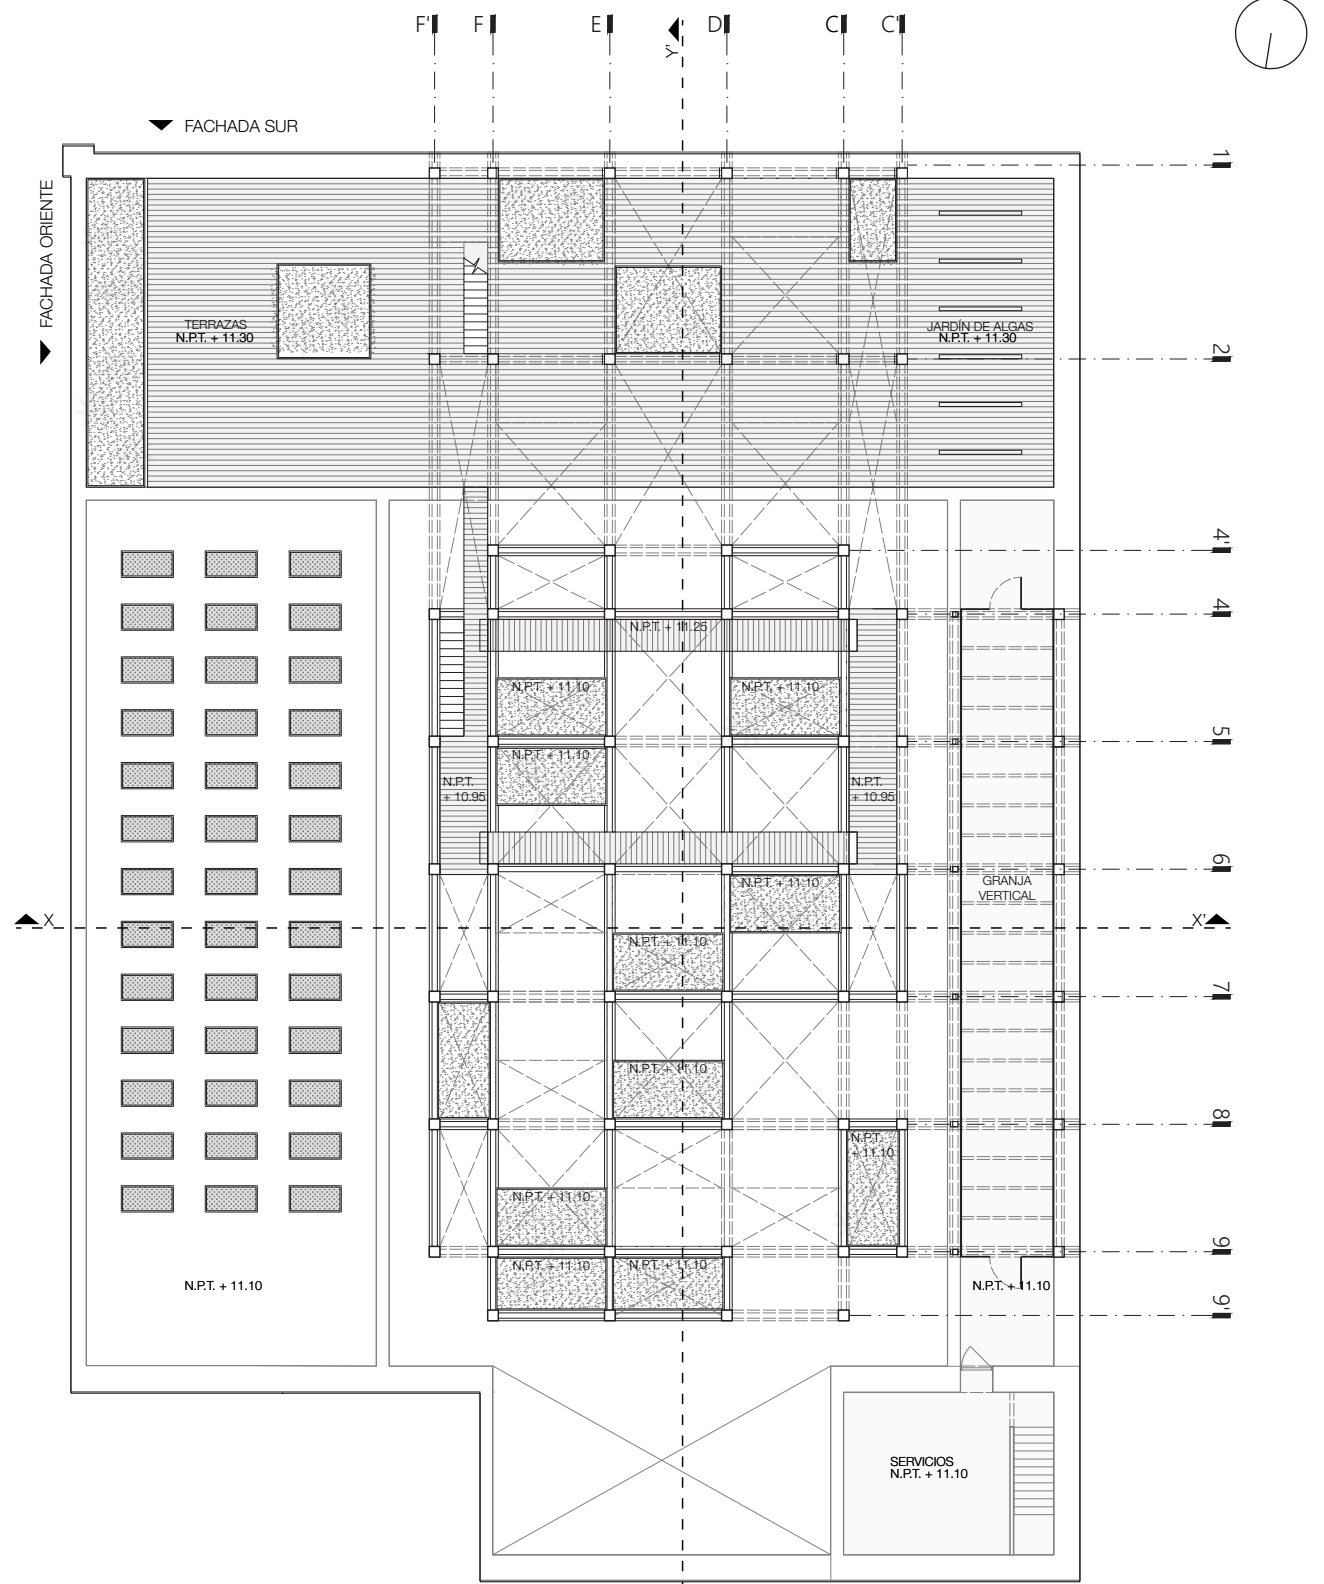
Planta arquitectónica nivel +11.10m. Fuente: Elaboración propia.
